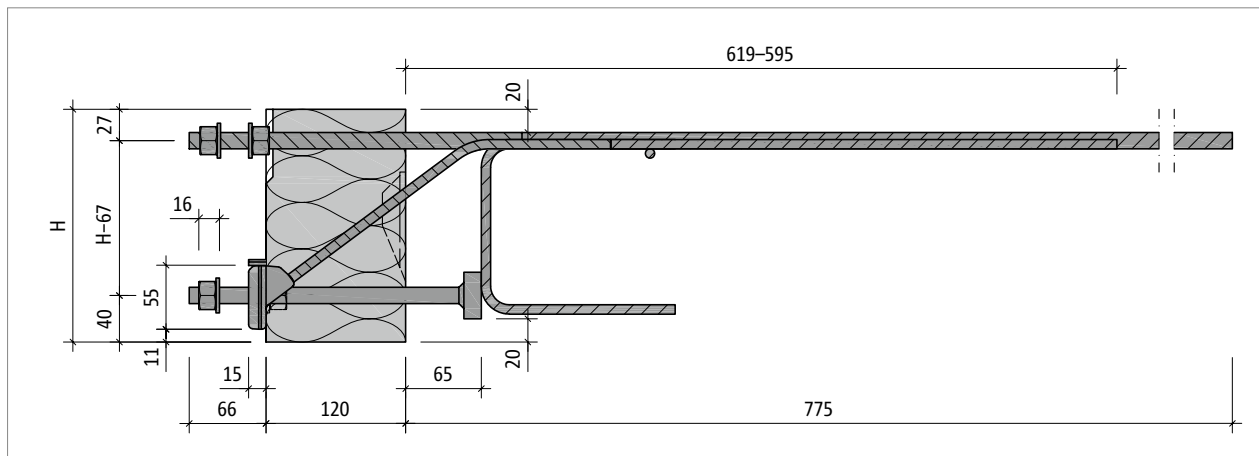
Schöck Isokorb® XT type SK-M1 : vue en coupe du produit
